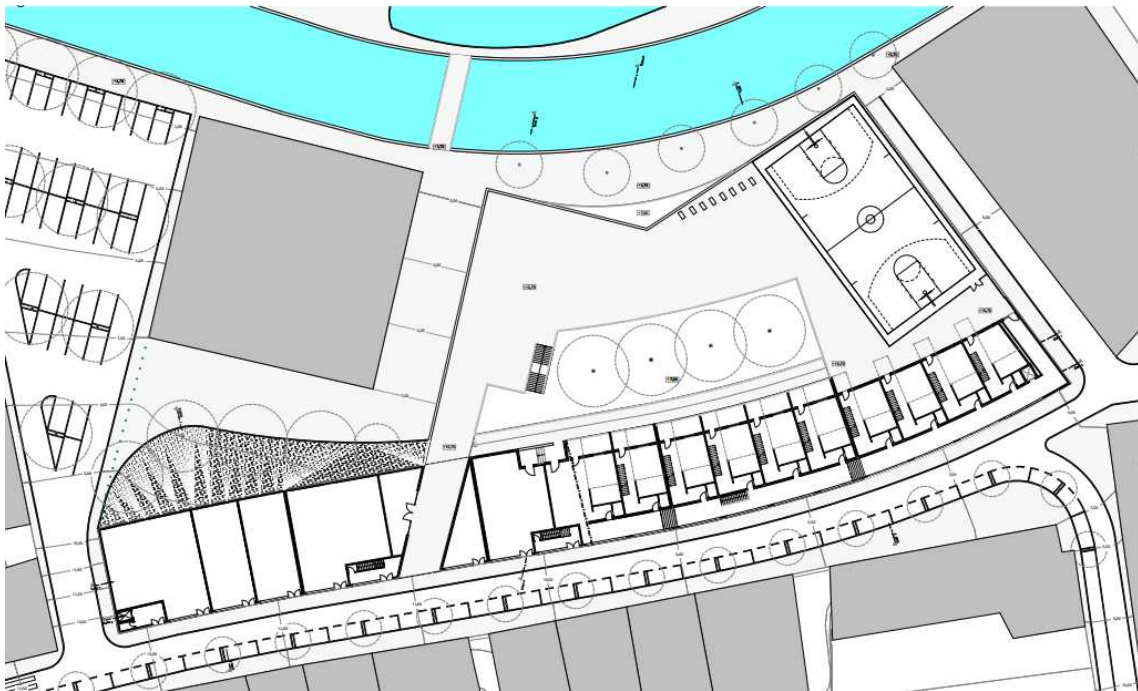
Painel final n.º4 - Habitação colectiva para jovens – Planta rés-do-chão II
